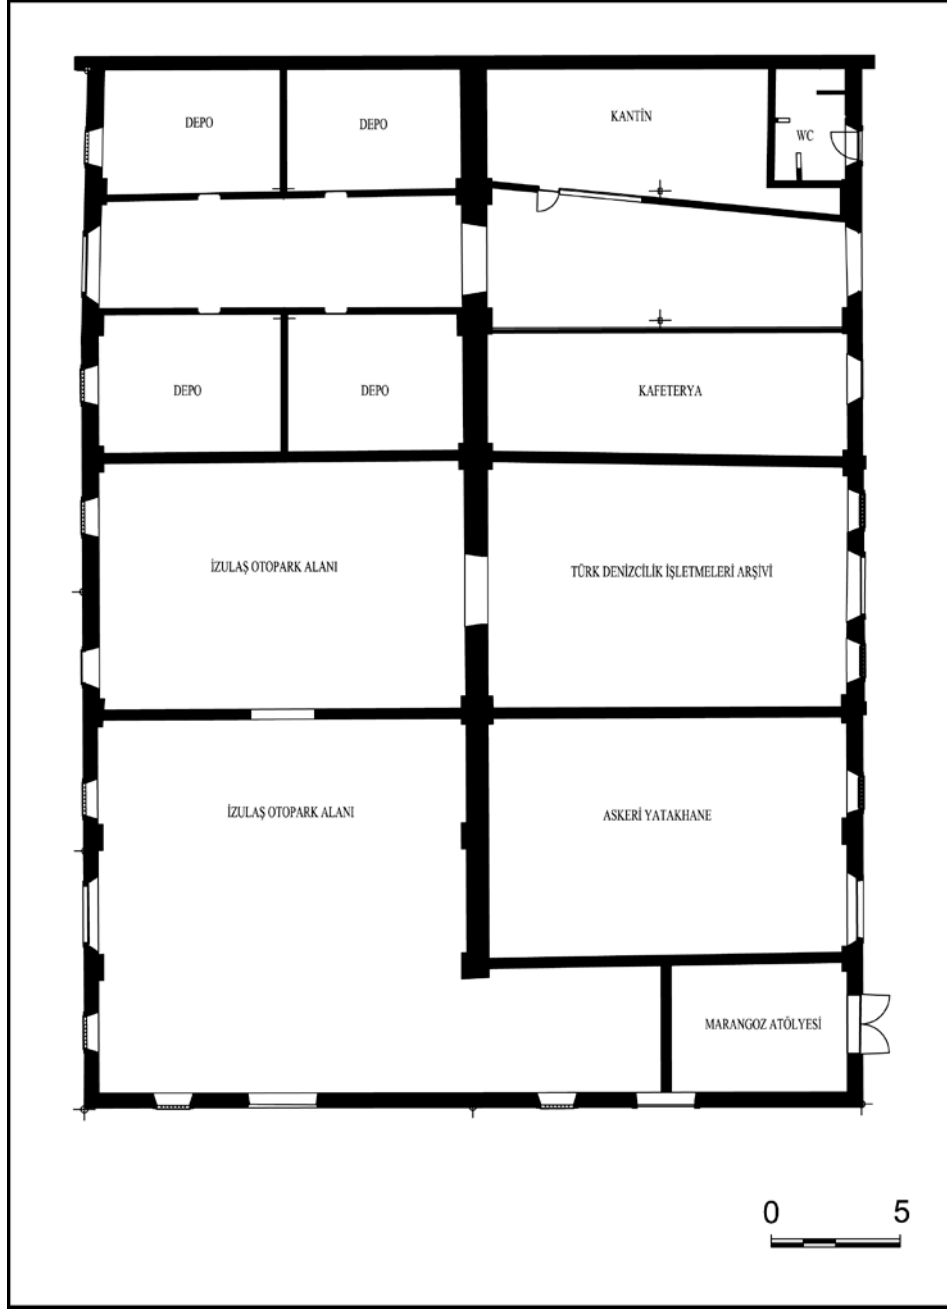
I. Dönem Karakol Filo Binası Plan Şeması
